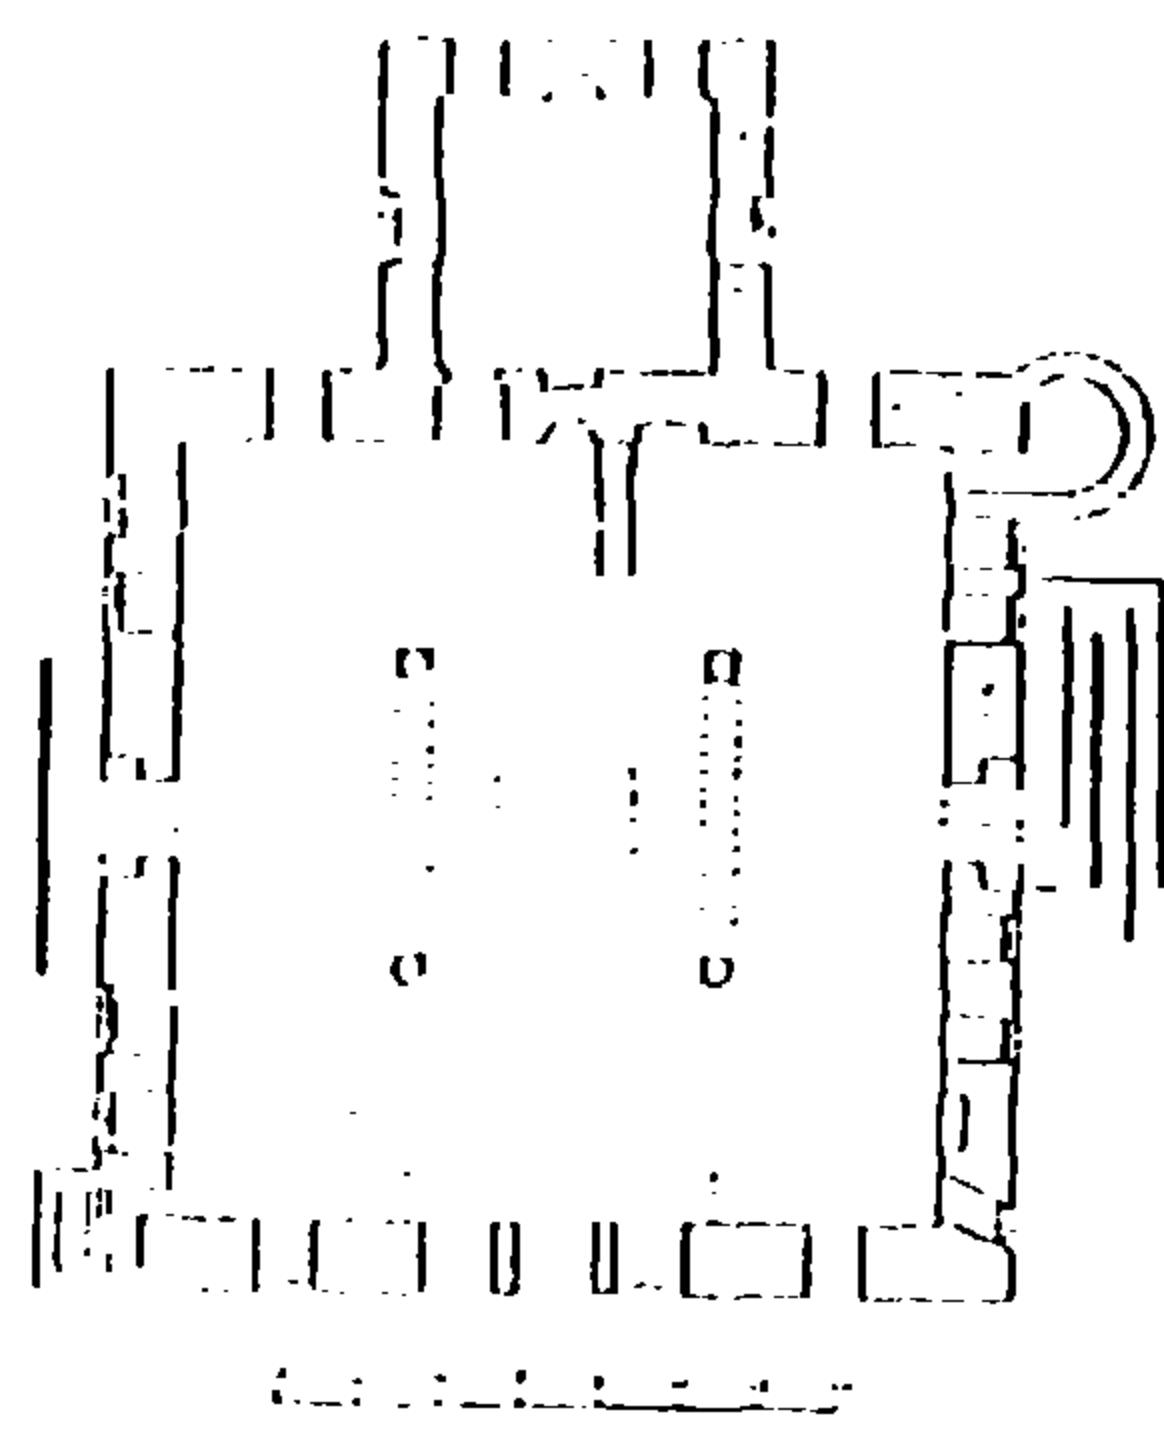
المسقط الأفقي لجامع الحبشي (الباحث)
